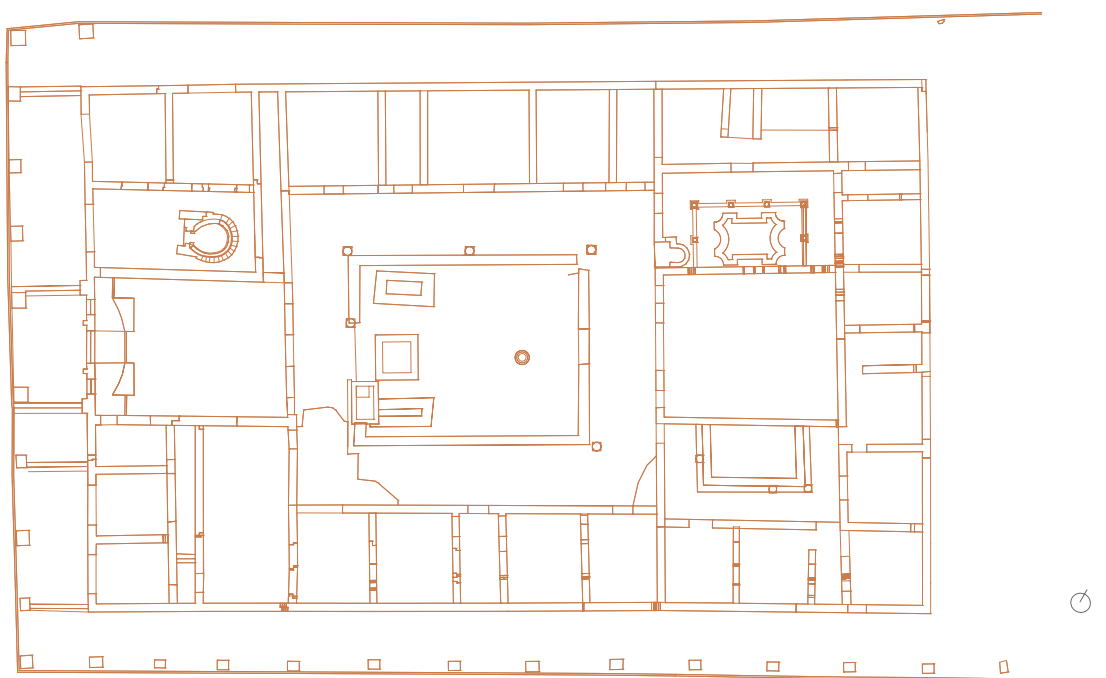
Plano del estado actual de la Casa de los Pájaros (fuente: R. Angulo, 2009. *Elaboración de las fichas diagnóstico de los bienes inmuebles del CAI*)
